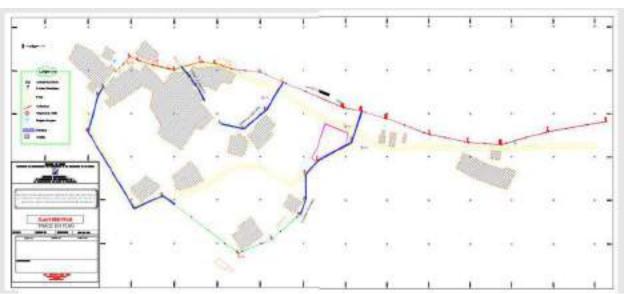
Plan du premier lot du projet d'assainissement de Taguant
